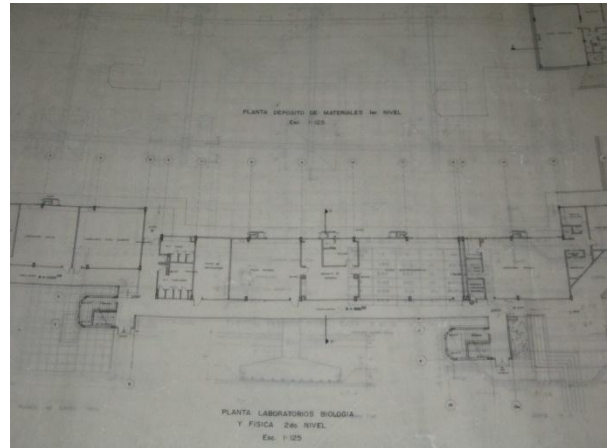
PL 2/46 Planta de distribución primer y segundo nivel.
